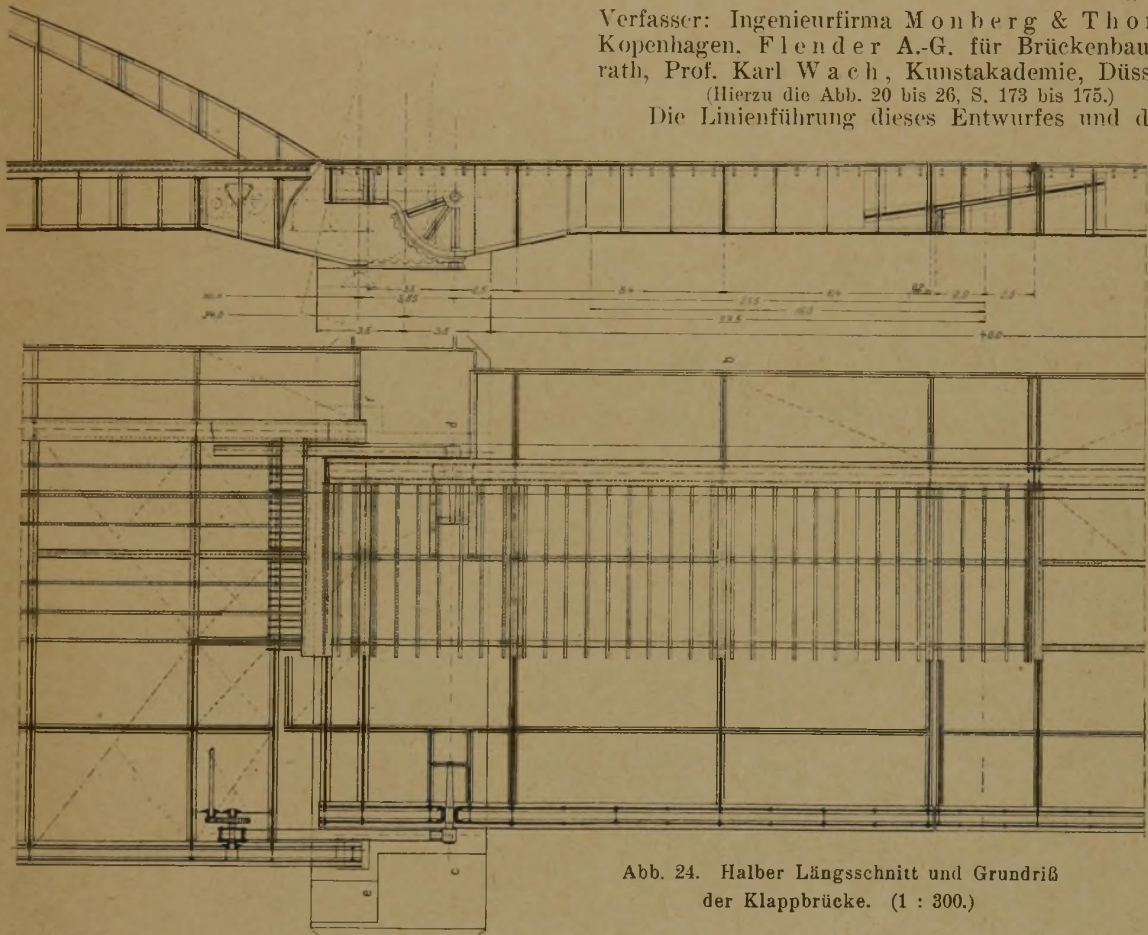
Halber Längsschnitt und Grundriß der Klappbrücke. (1 : 300.)
